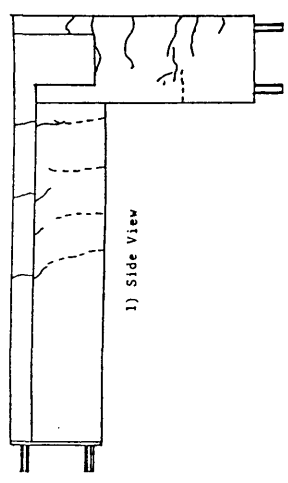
ひびわれ状況 (ε) 試験体T-1
